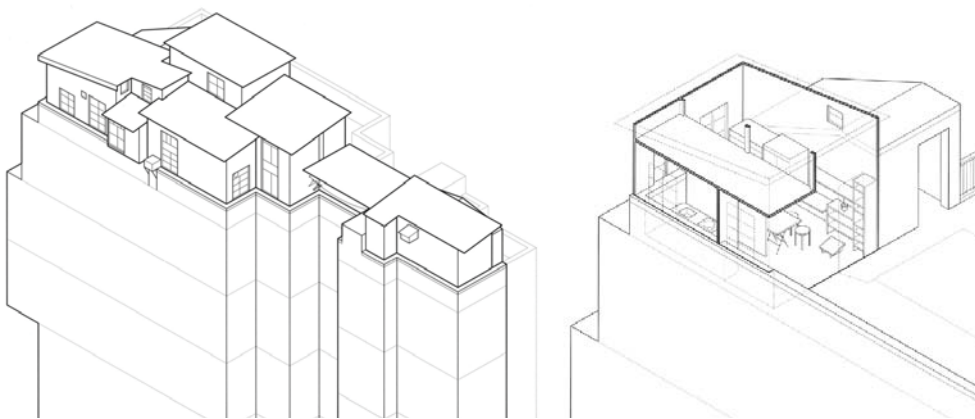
Illegale Dachaufbauten in Sham Shui Po, isometrische Darstellung
